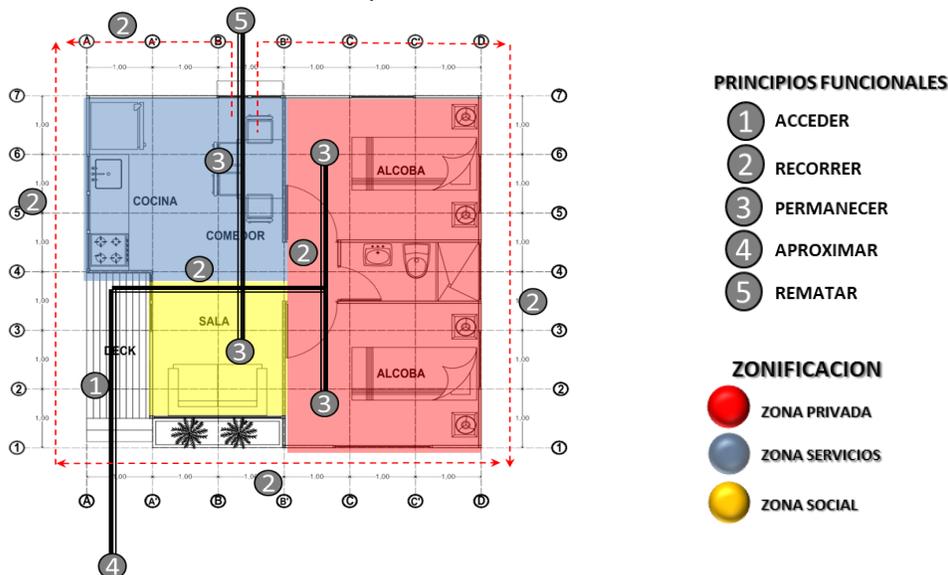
Planta Distribución Propuesta Vivienda 36m<sup>2</sup>, Fuente: Elaboración propia
